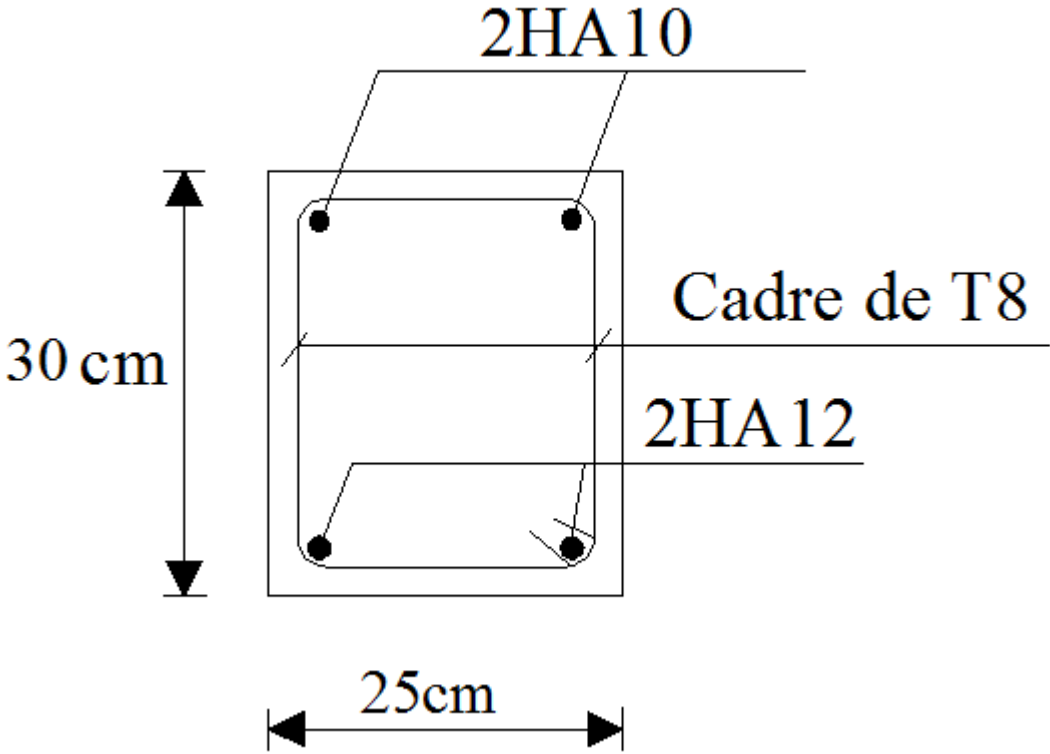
coupe A-A de ferrailage de la poutre palière
